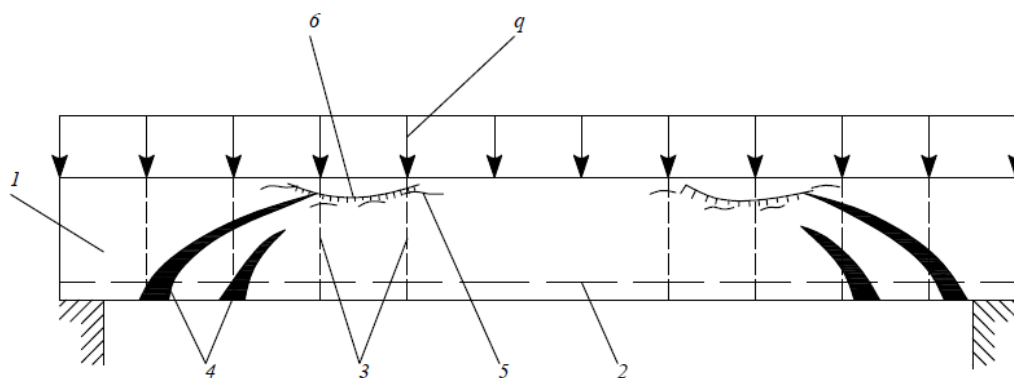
Разрушение бетона сжатой зоны над наклонной трещиной: 1 – изгибаемый элемент; 2 – рабочая арматура растянутой зоны; 3 – поперечная арматура; 4 – наклонные трещины ширины раскрытия более 1,0 мм; 5 – трещины в сжатой зоне по наклонному сечению над наклонной трещиной (раздробление бетона); 6 – отслоение бетона в сжатой зоне сечения.
